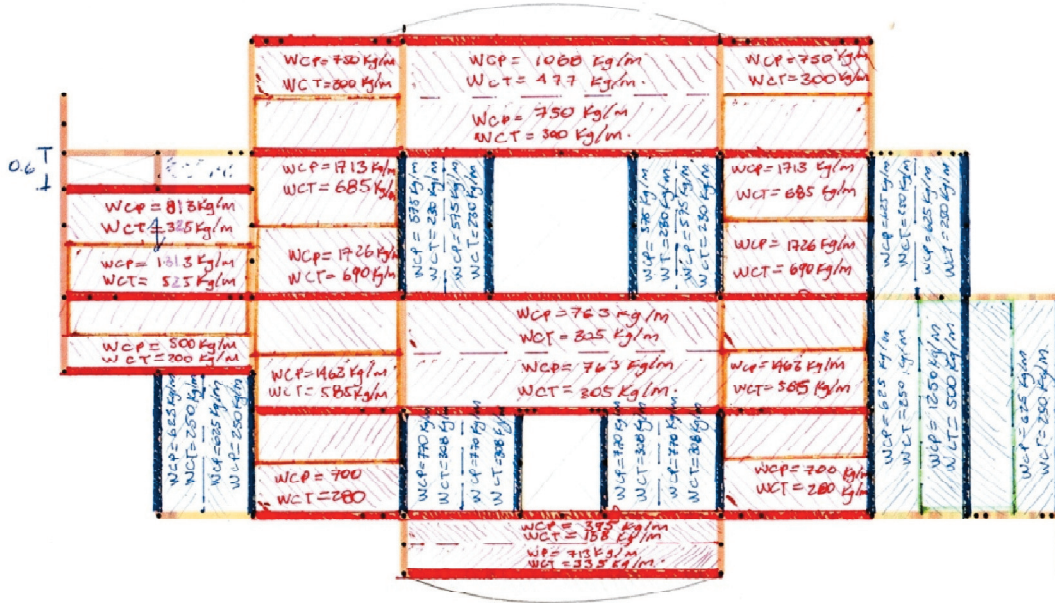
Cargas en vigas de entrepiso edificio central o C.
